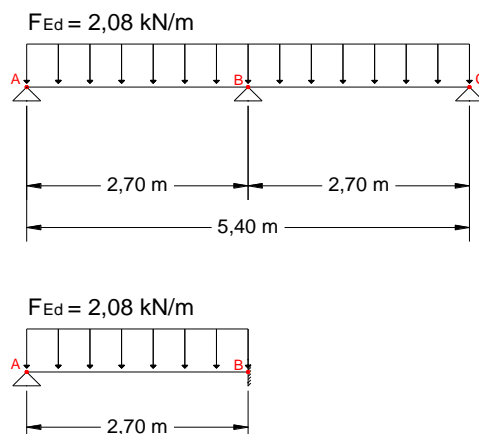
Esquema do modelo adotado para o cálculo do corte nas vigas V2 a V5
